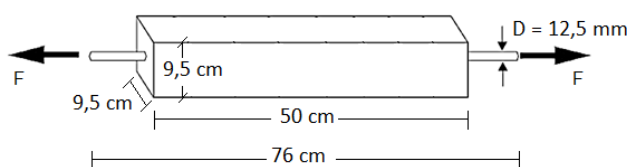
Dimensões do corpo de prova do ensaio de tension stiffening
